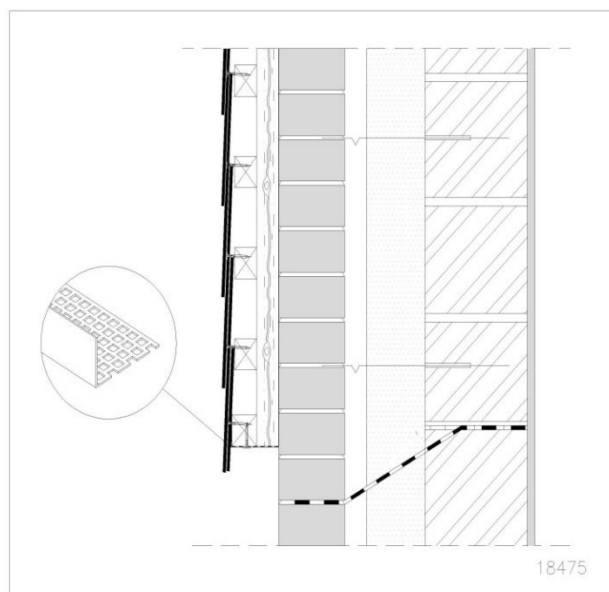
Onderrand - voorzetgevel – verticale doorsnede
